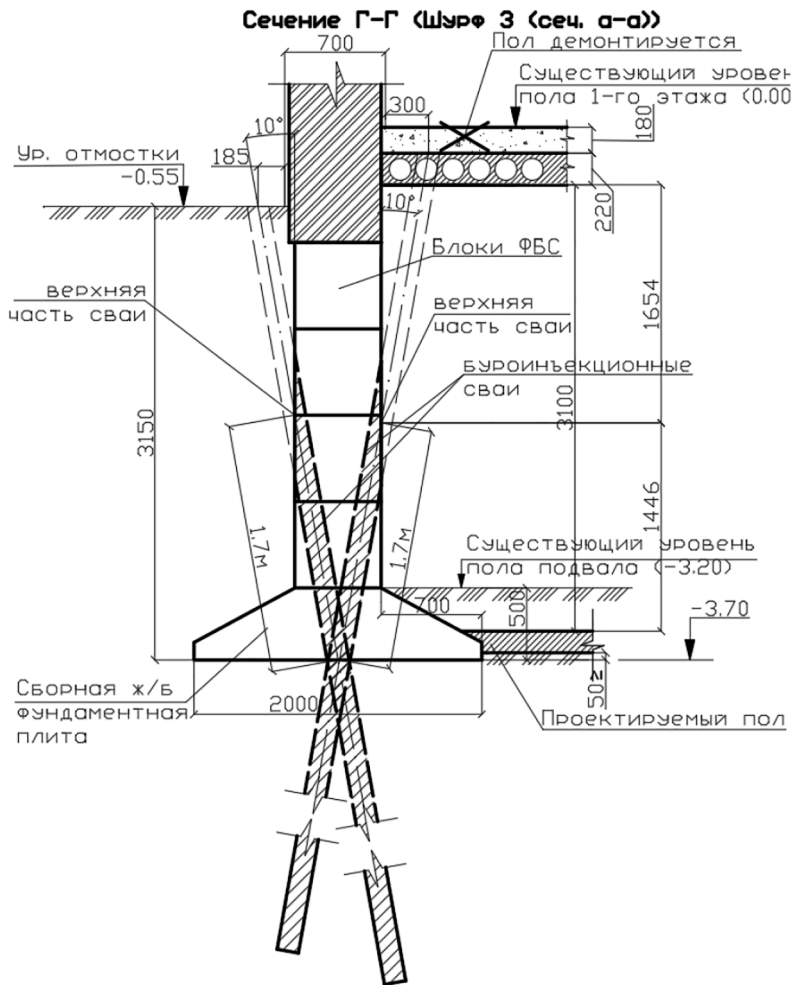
Поперечное сечение Г-Г усиленного основания фундамента
